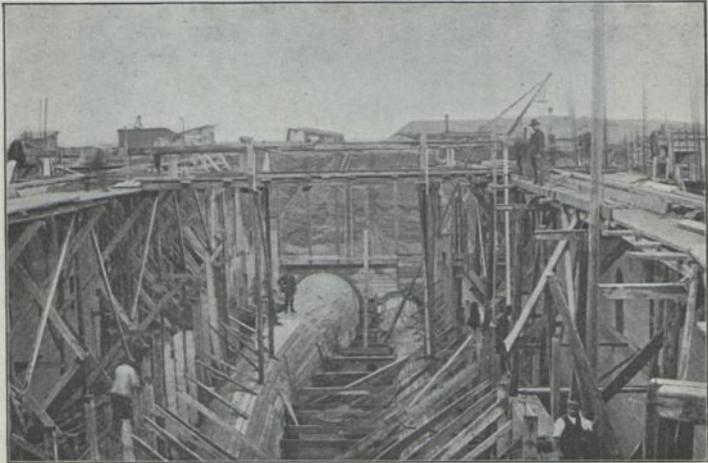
Bau-, Förder- und Arbeitsgerüste beim Dresdner Pumpwerksbau in Kaditz.
